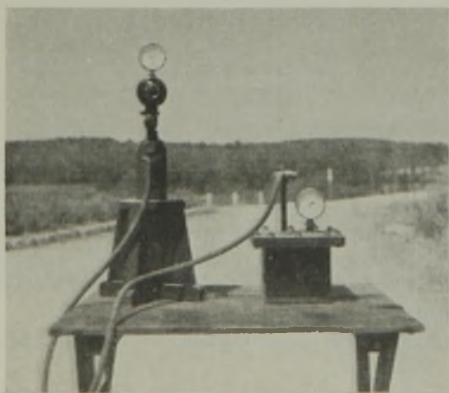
Prüfung auf Undurchlässigkeit der Bitumendecke.
